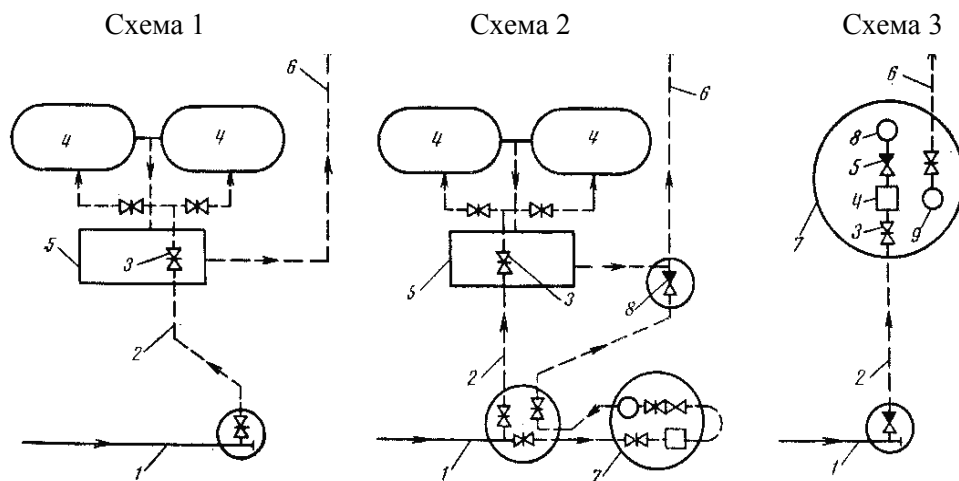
Схемы подключения систем водоснабжения к водоводам групповых водопроводов
